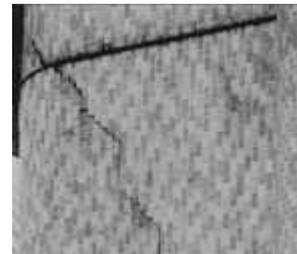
fissuration au niveau des joints [Chew 99]
